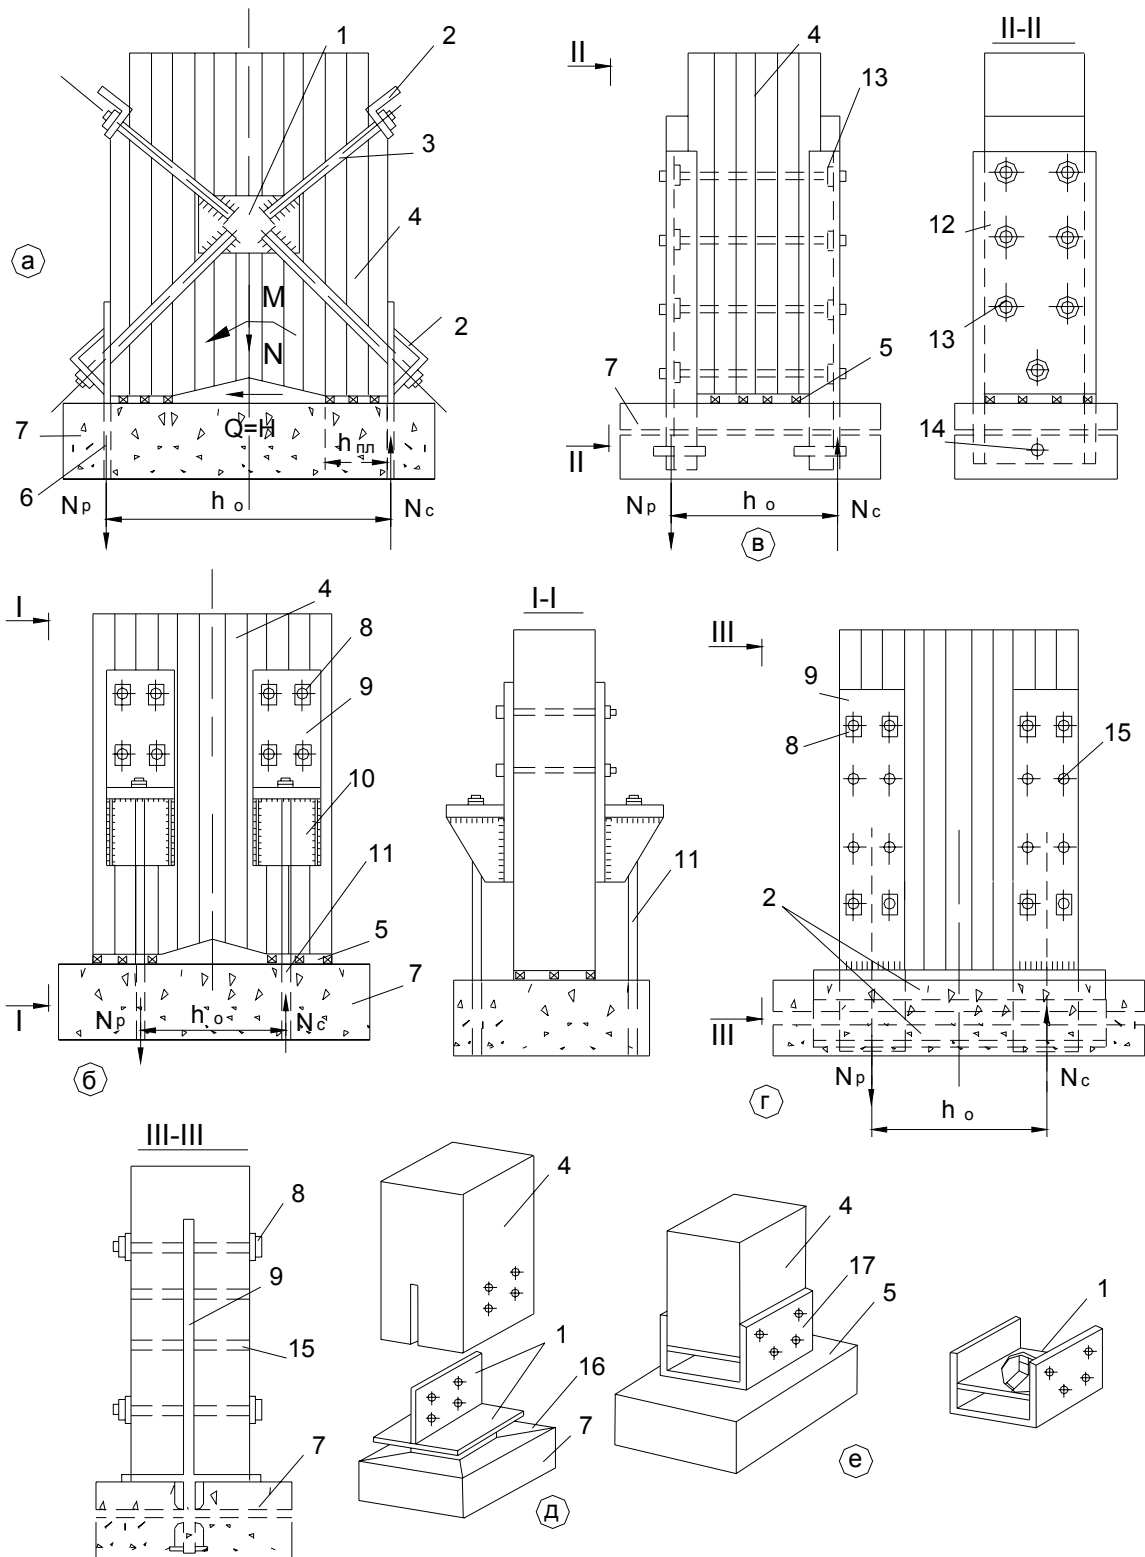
Опорные узлы жестко защемленных (а – г) и шарнирно опирающихся сжатых стоек (д, е): 1 – фанонка; 2 – уголок; 3 – тяж; 4 – стояк; 5 – изоляция; 6 – анкер из полосовой стали; 7 – фундамент; 8 – болт; 9 – планка; 10 – сварной столик; 11 – анкер из круглой стали; 12 – швеллер; 13 – зубчатая шпонка; 14 – штырь; 15 – нагель; 16 – квадратная труба; 17 – гнутая фанонка
